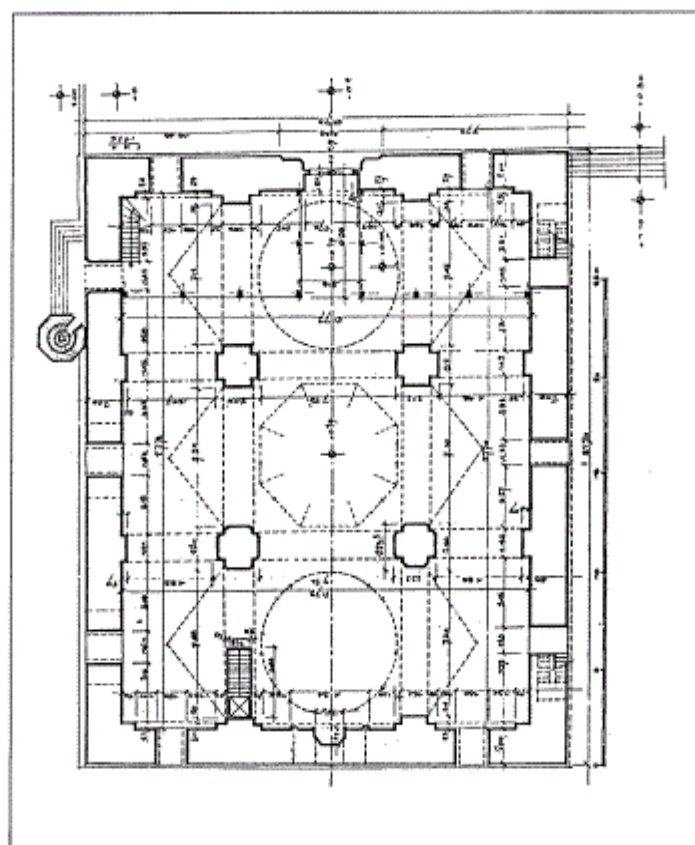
مسقط أفقي لمسجد بايزيد الثاني في بيرات بالبلاتيا (عن : كيل)
